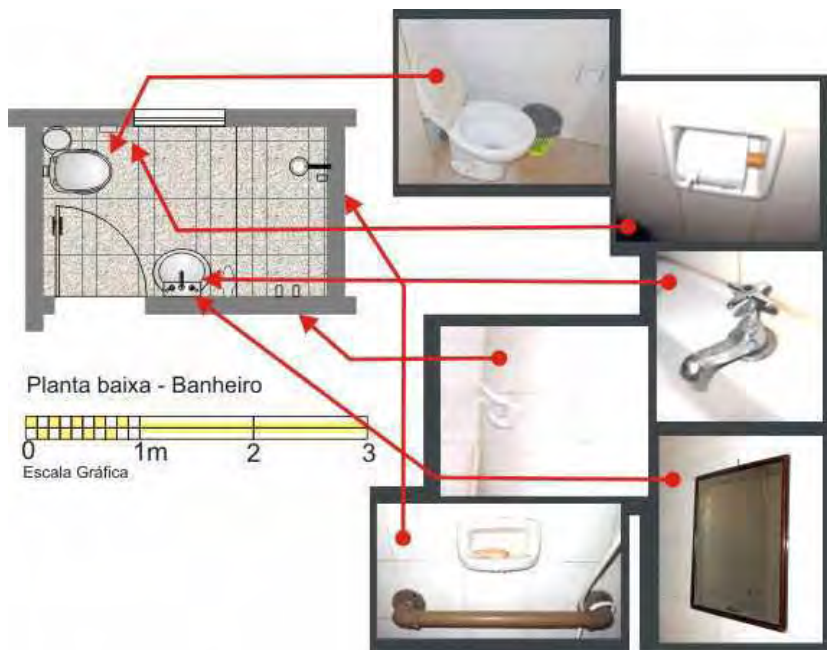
Planta e Imagens do Banheiro - Asilo
